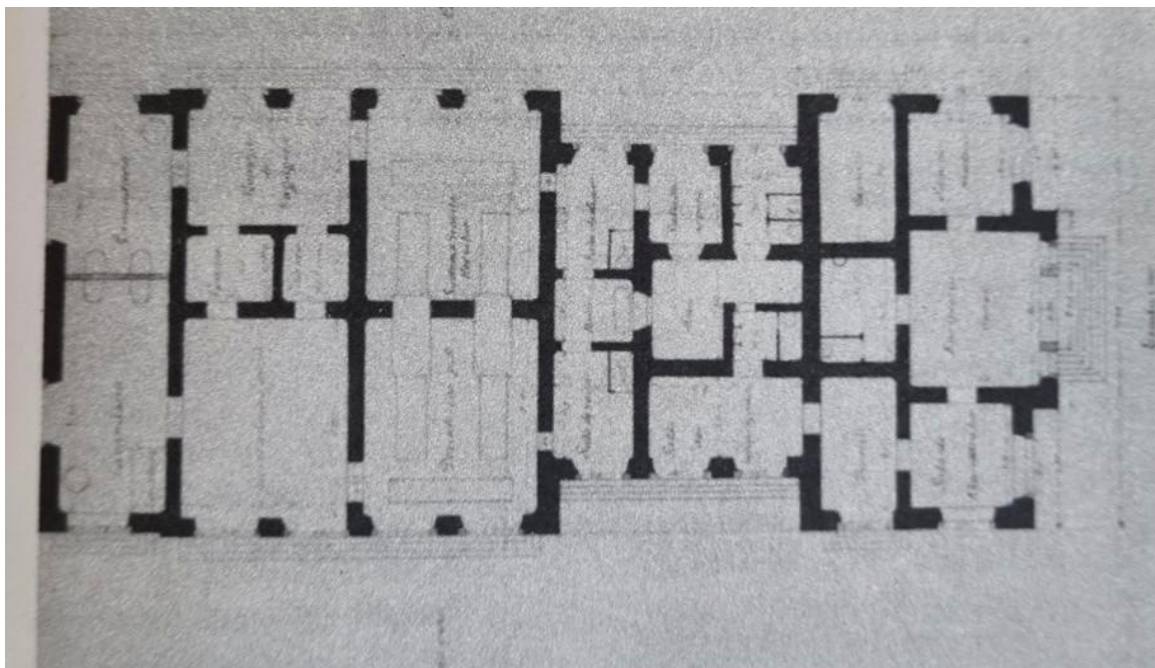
Plano de planta del Centro de Desinfección de Botafogo, en 1905
